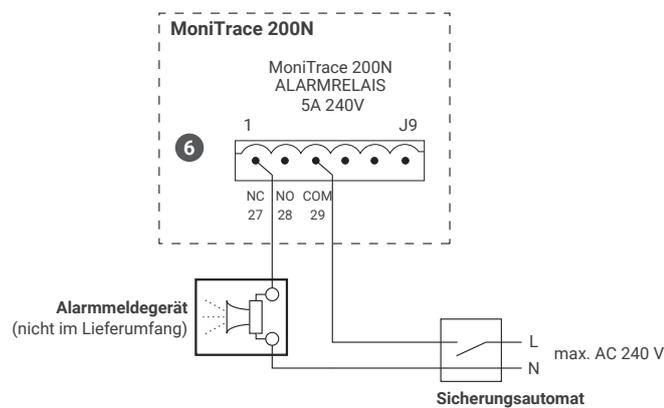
Anschluß einer externen Alarmvorrichtung
